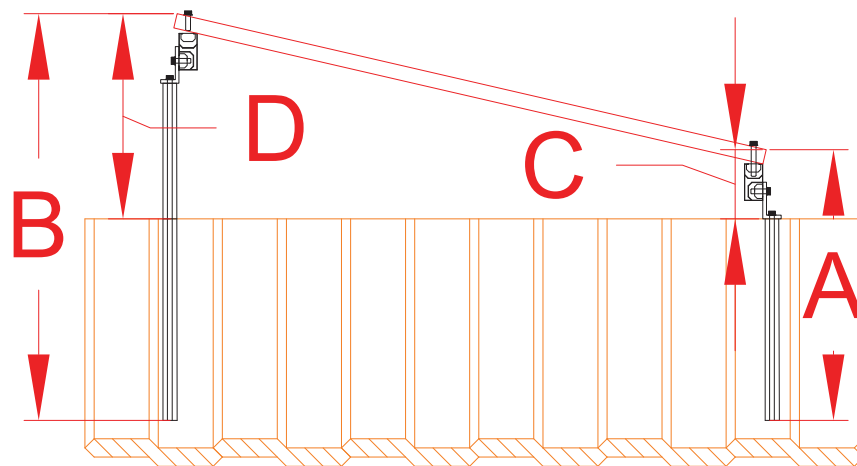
Vista frontal de estructuras inclinadas al Este.
